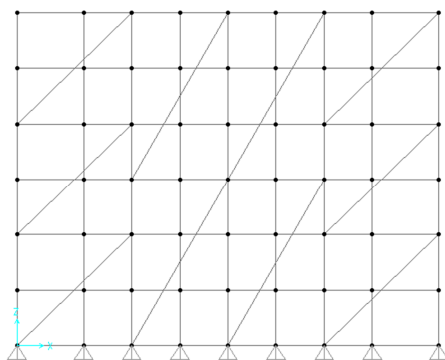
Configuração dos Planos de Contraventamento Vertical Com Elementos de Contraventamento Grandes
